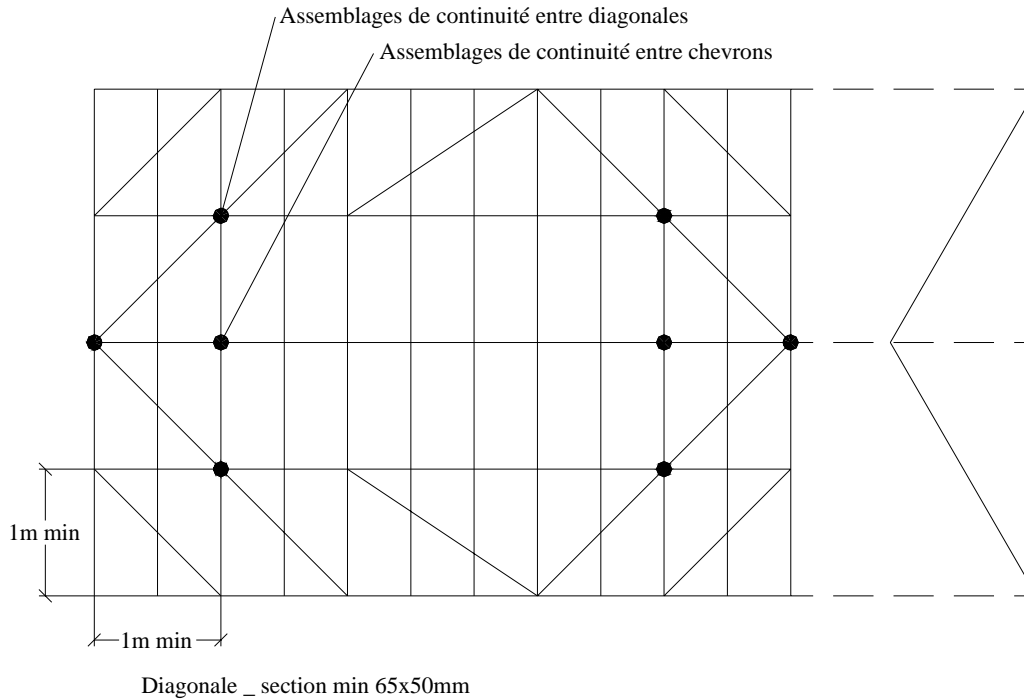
Contreventement de toiture. Absence de ferme. Combles habitables. Utilisation de sections de bois. Cas de la toiture à pannes continues.
